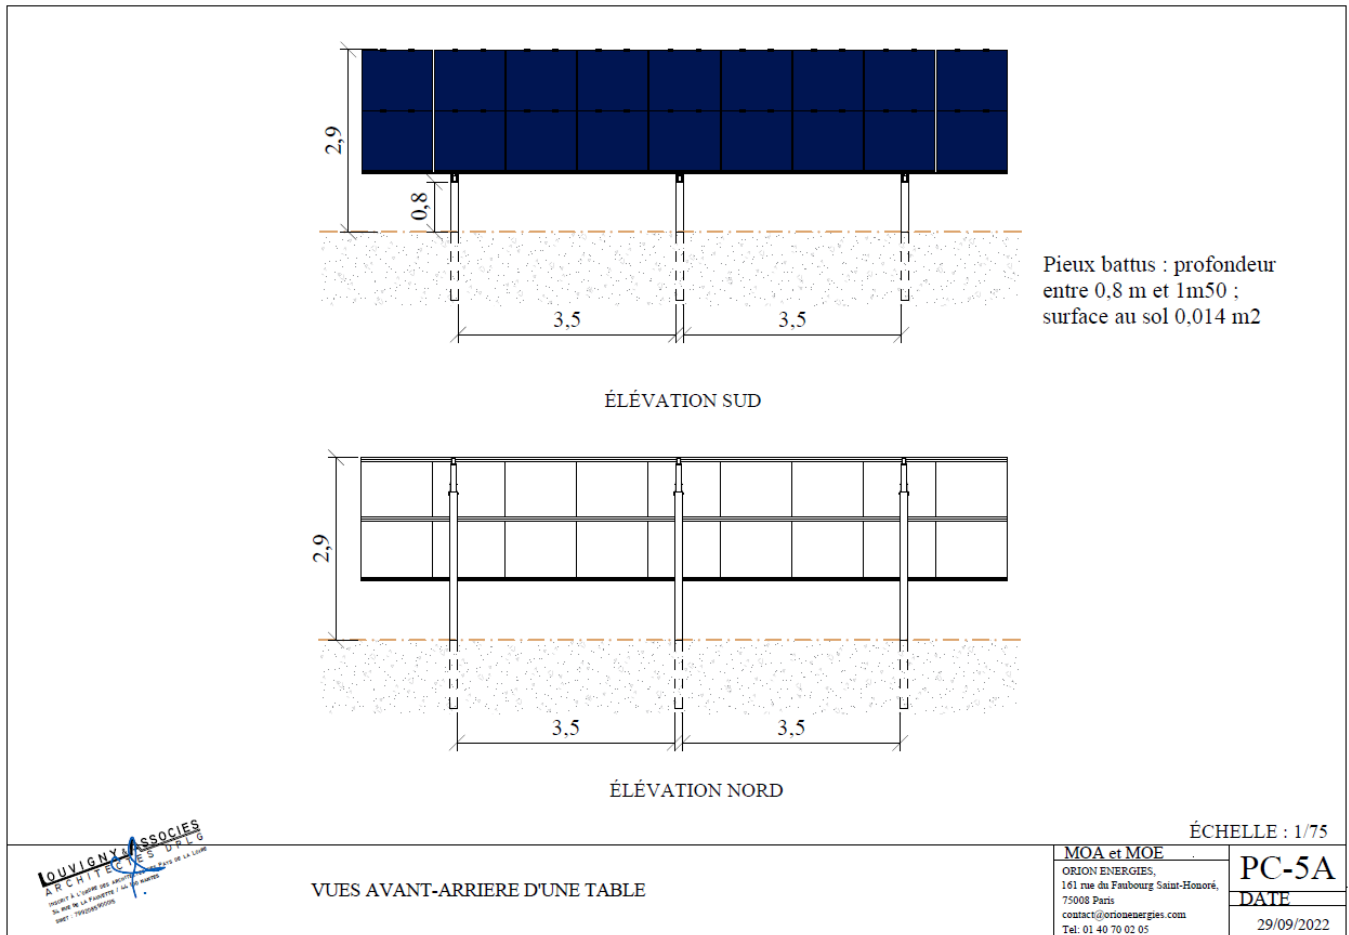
extraits des plans de masse du projet (Source : dossier de permis de construire)
